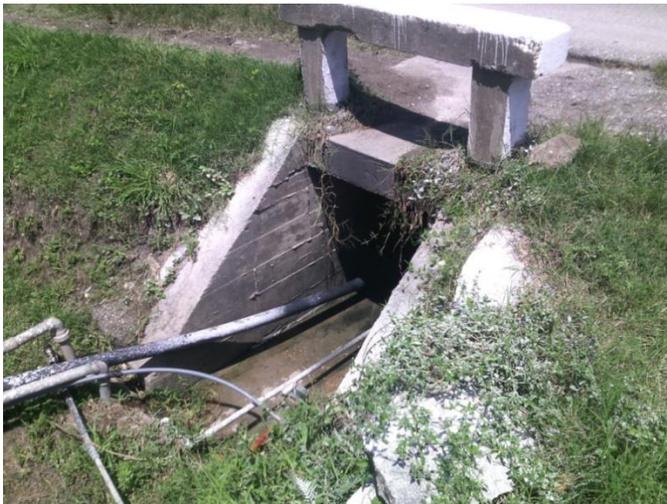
Vista en planta de la OF 2. Dimensiones 1,00x1,00m.
